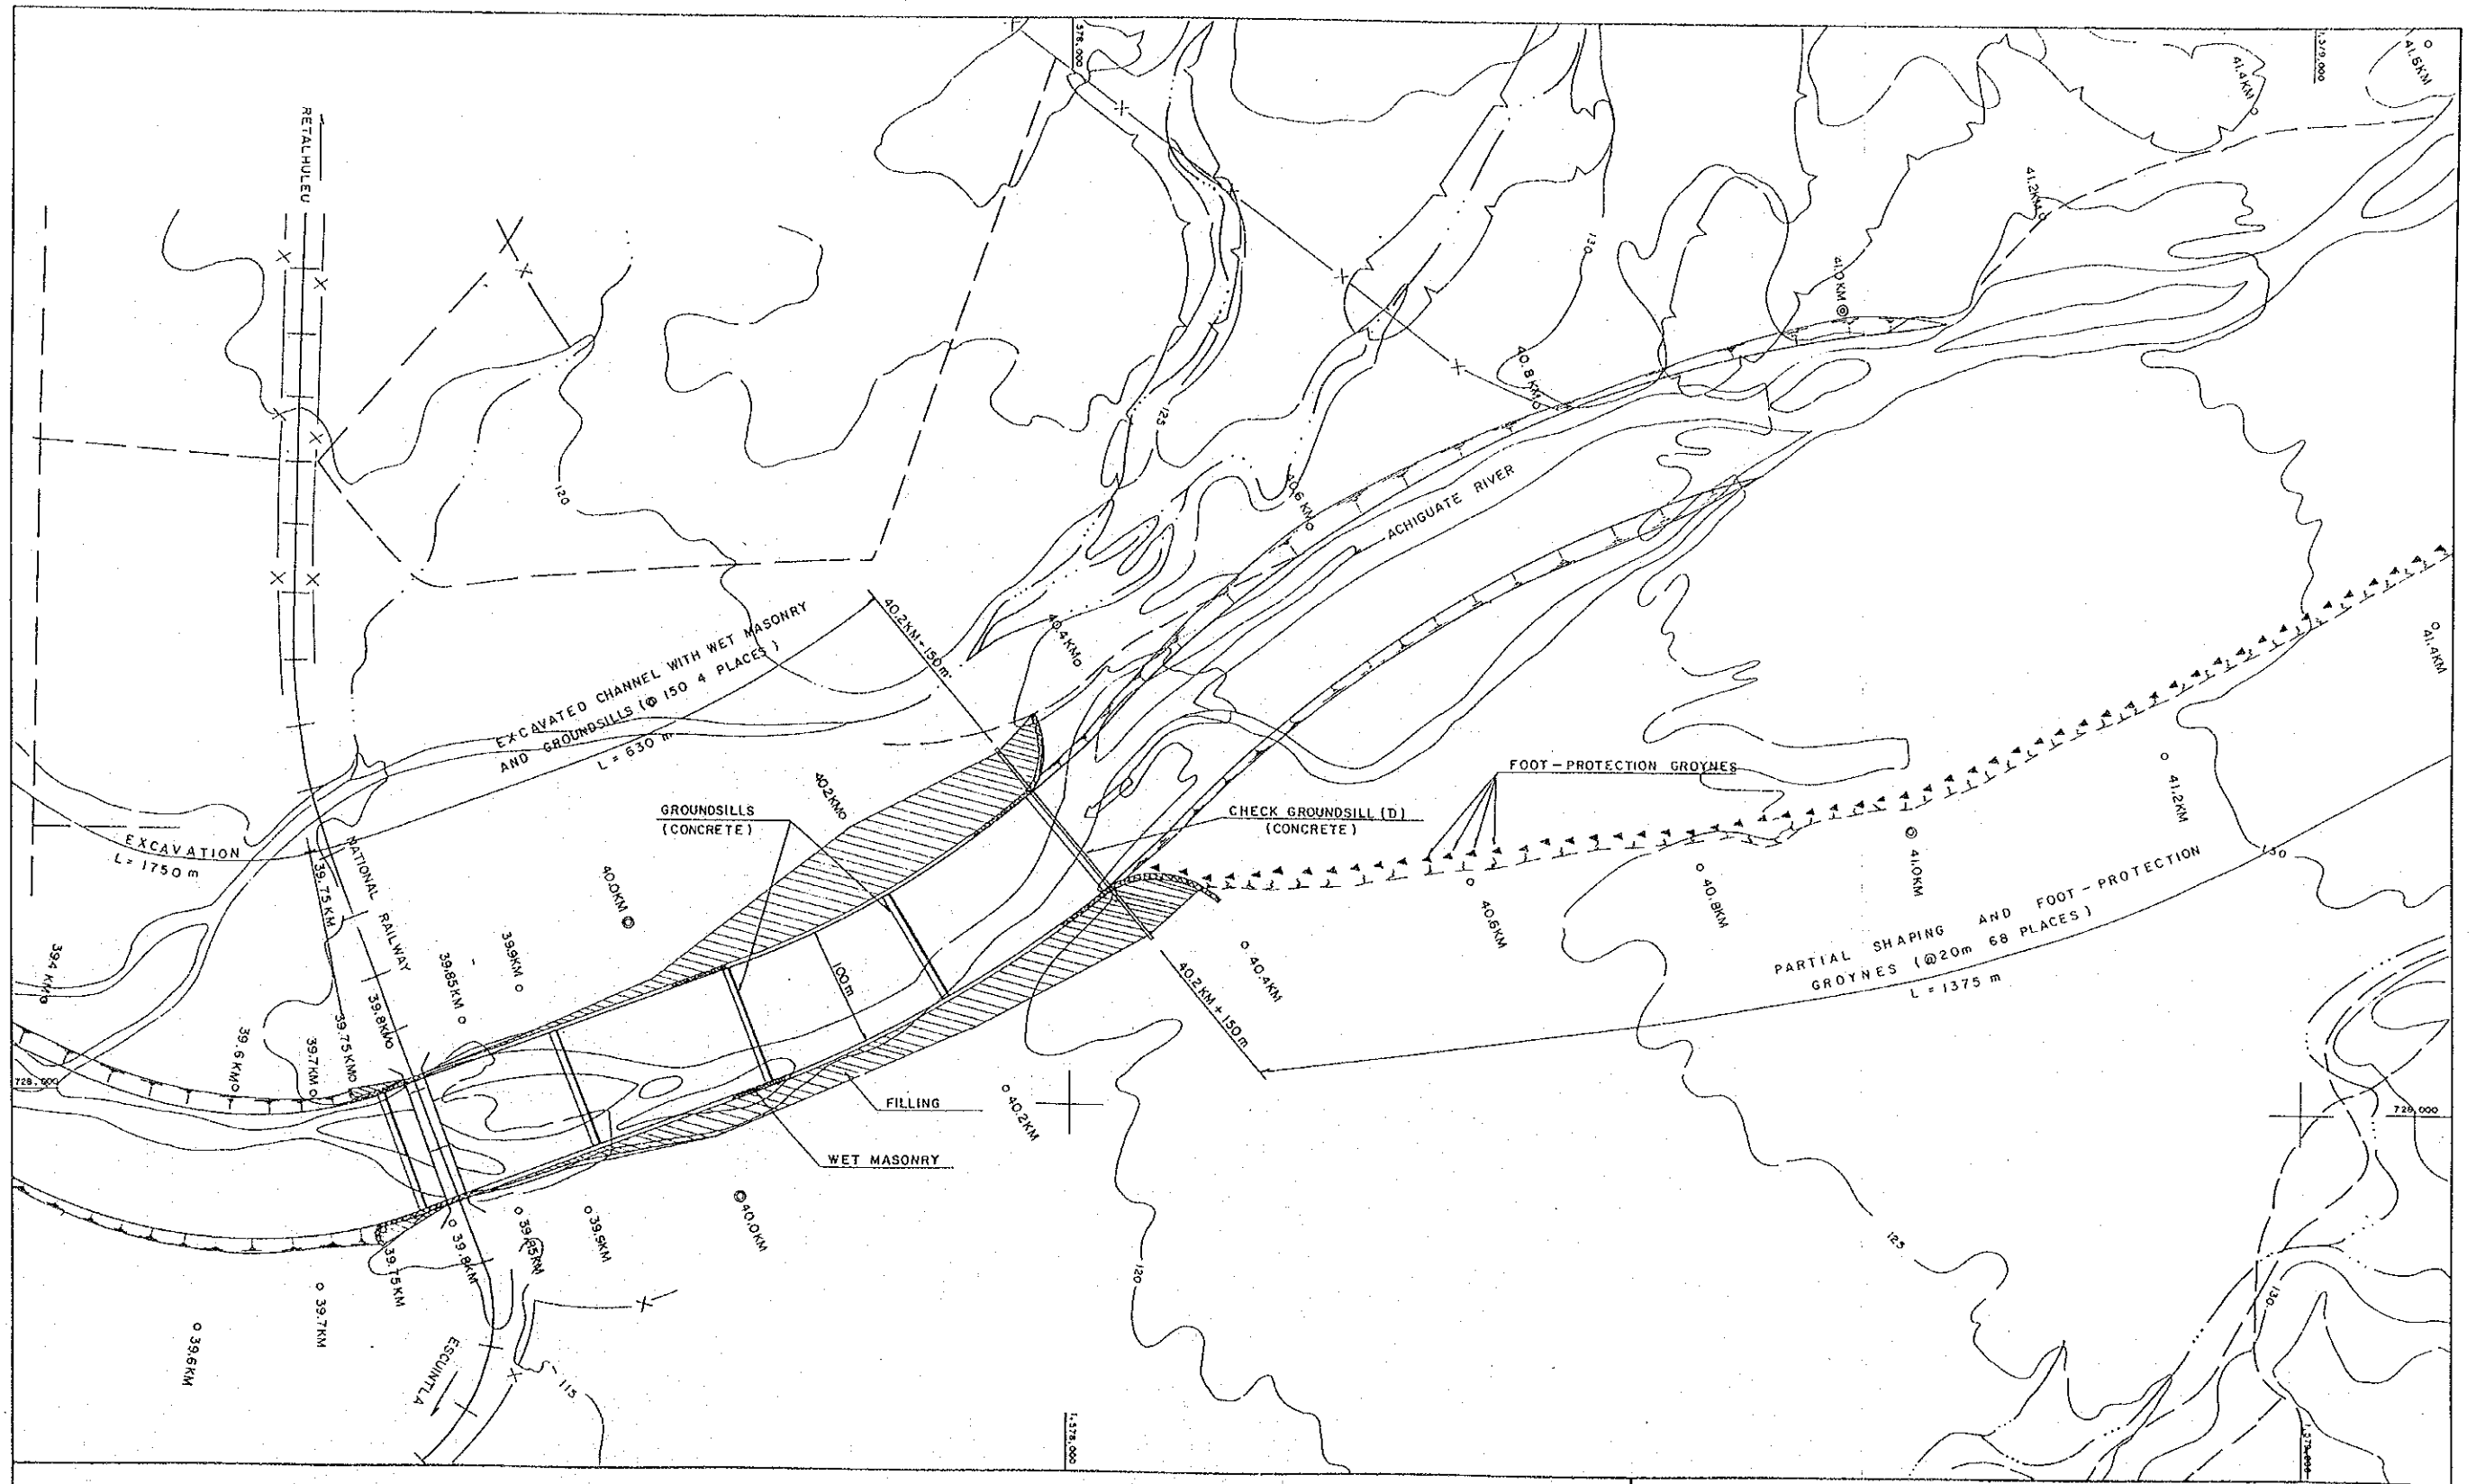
(1/6) PLAN DE MEJORAMIENTO DEL CAUCE (PLAN PROPUESTO) (RIO ACHIGUATE)
